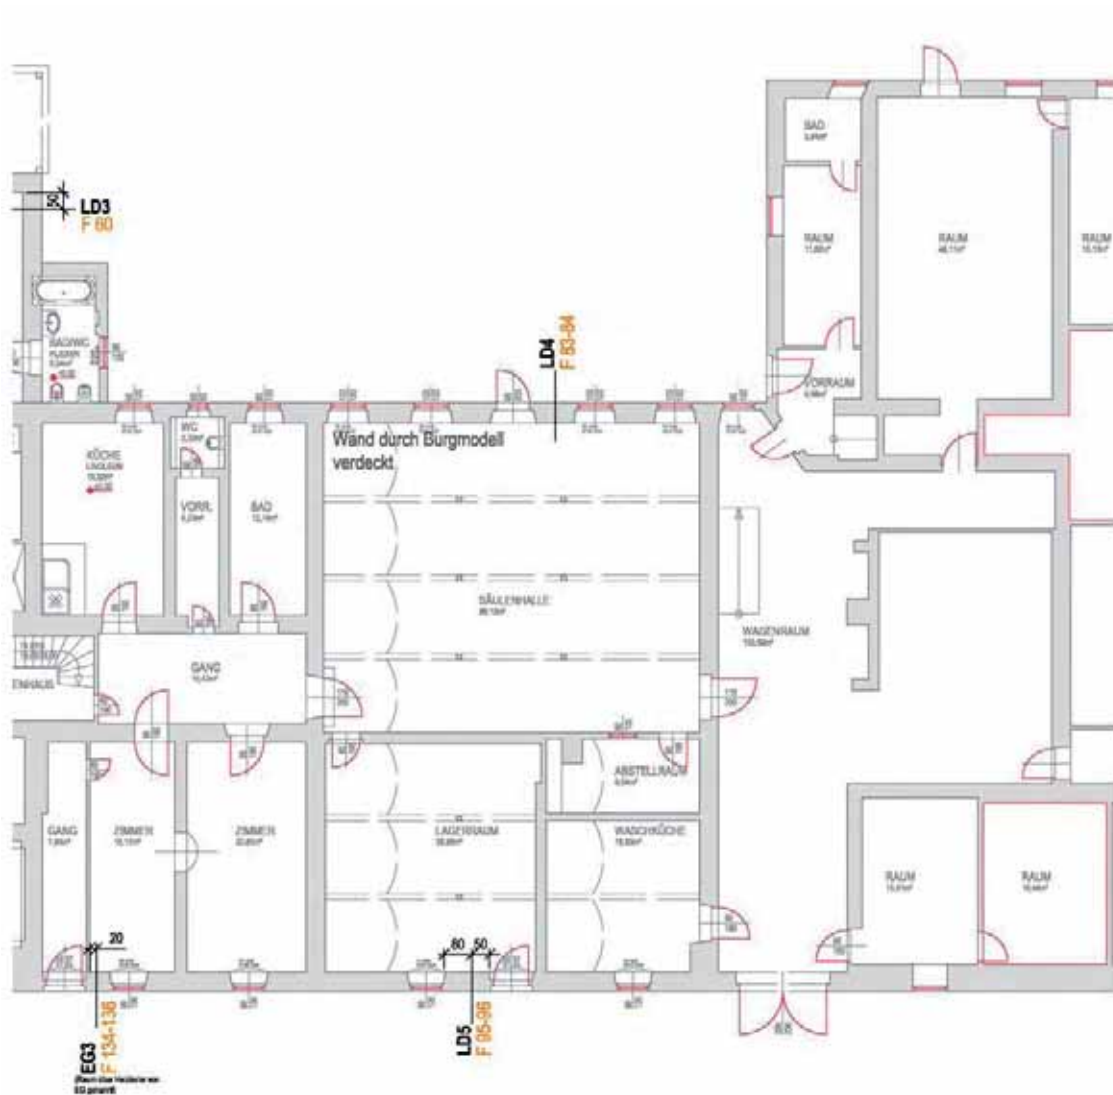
Plan A3 – 2: Position der Achsen 4 (LD 4) bis 5 (LD 5) im Grundriss;
